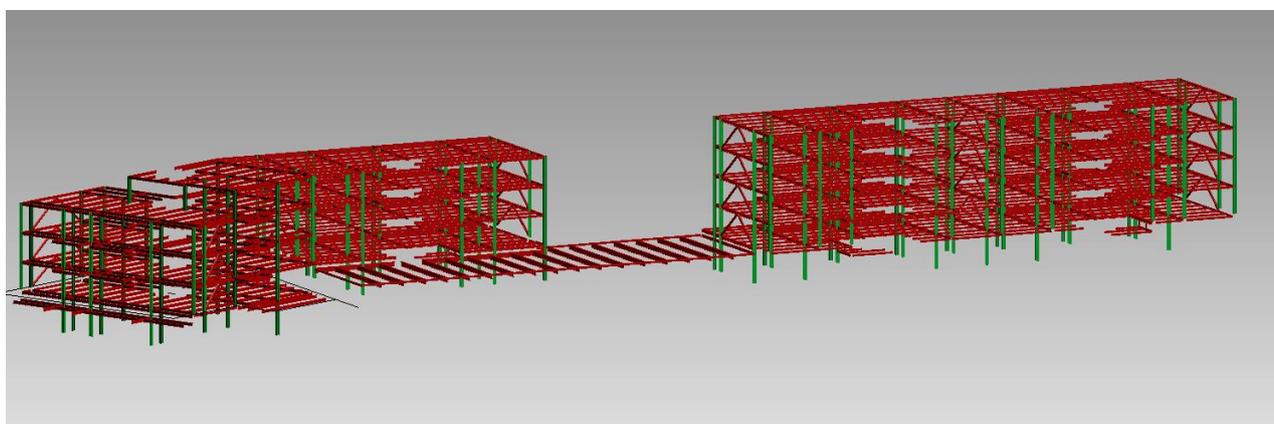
Elementos estruturais metálicos (pilares e vigas)
